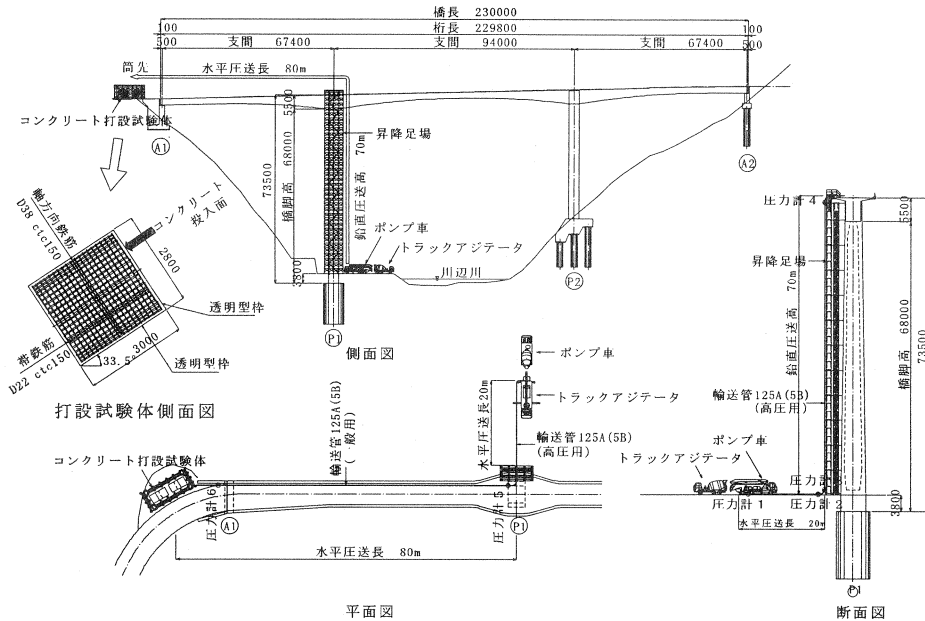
ポンプ圧送試験概要図 (単位のない長さは mm)
